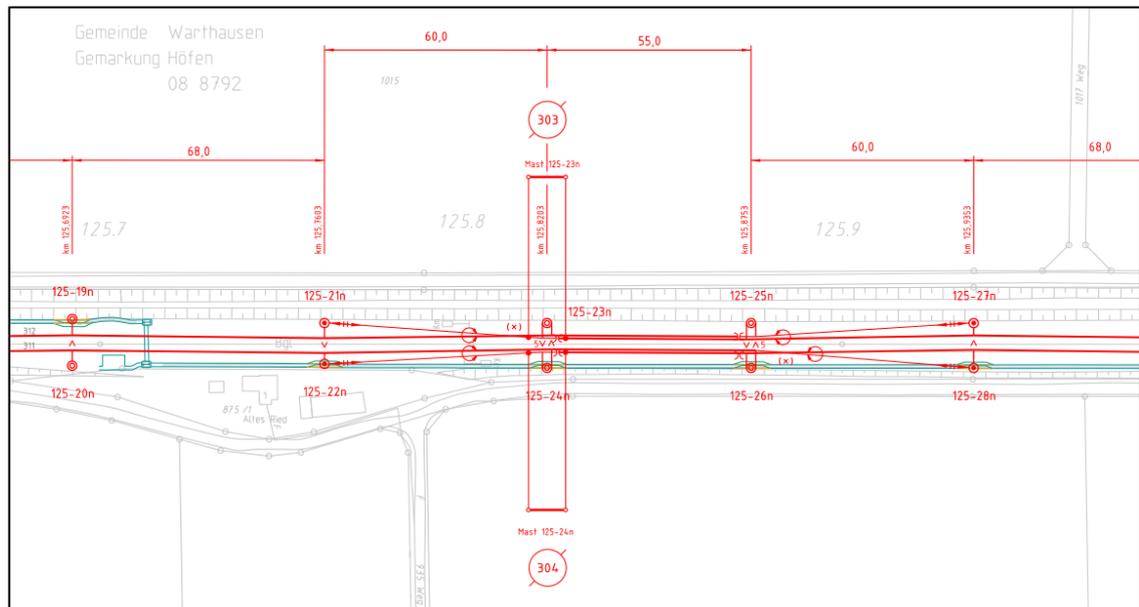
Ausschnitt Oberleitungs-Lageplan Elektrifizierung Südbahn;
